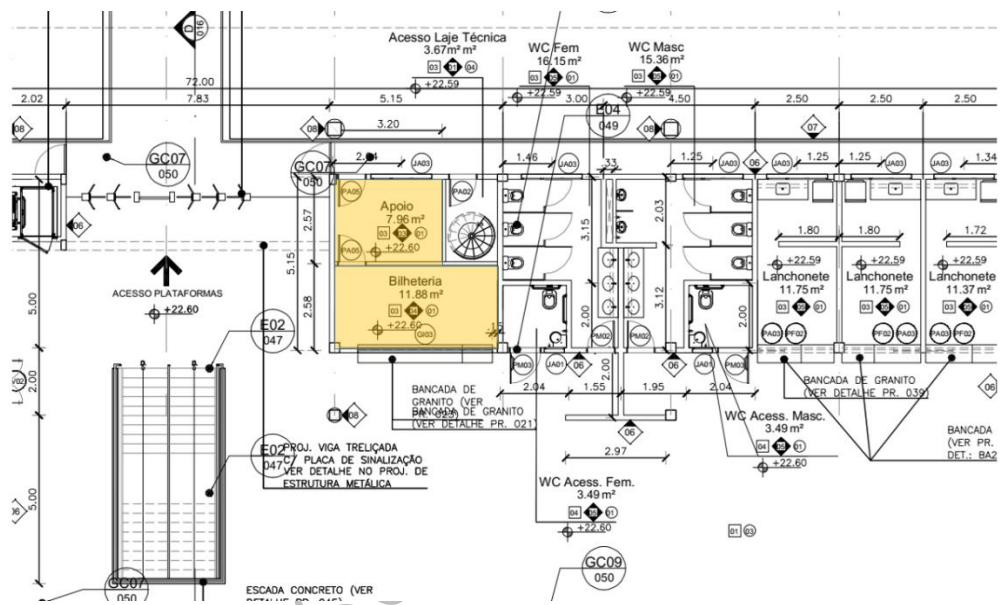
Área do Posto de Venda (Bilheteria e Apoio) do Terminal Marituba
